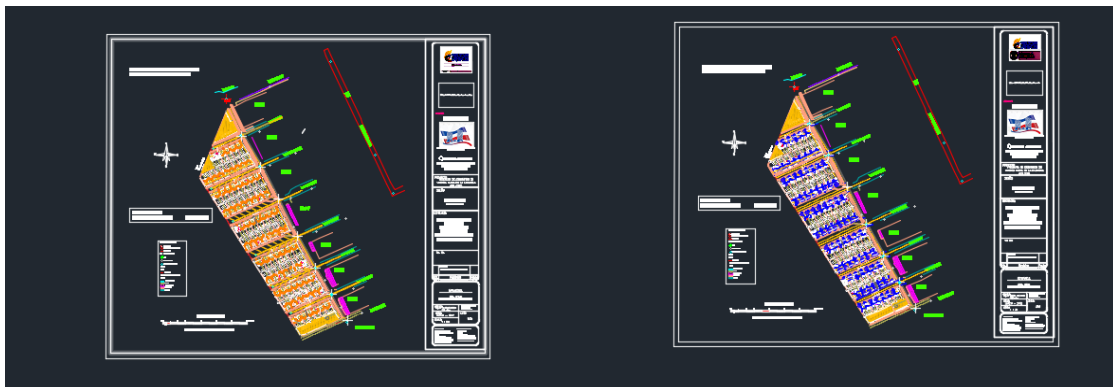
Plano alcantarillado vivienda unifamiliar primer piso.
